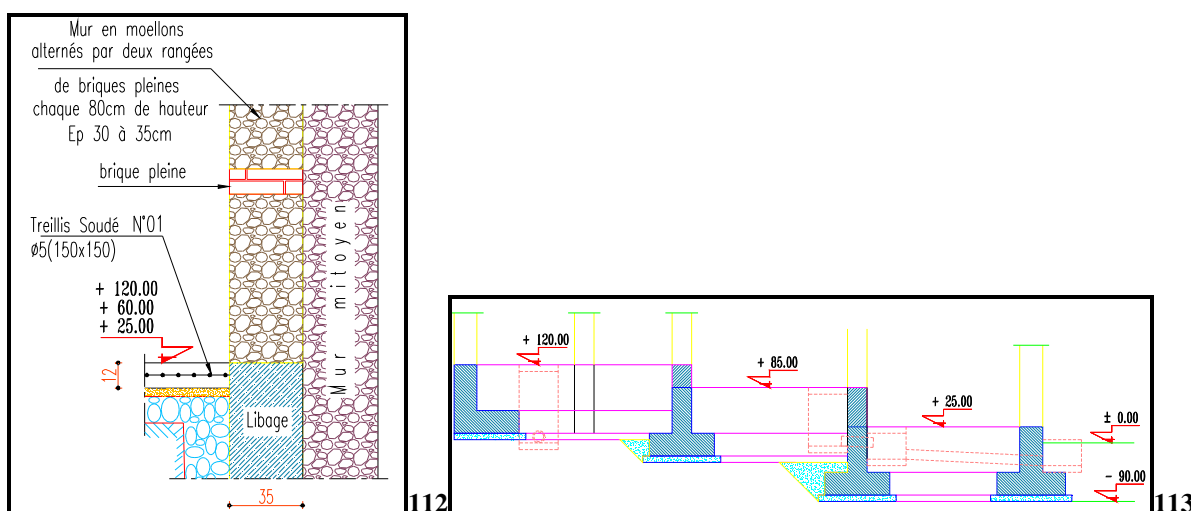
Détail en élévation du système de renforcement des murs, bloc maisons 12. Figure 113 : Détail en élévation de positionnement des structures porteuses. Bloc maison 12.
